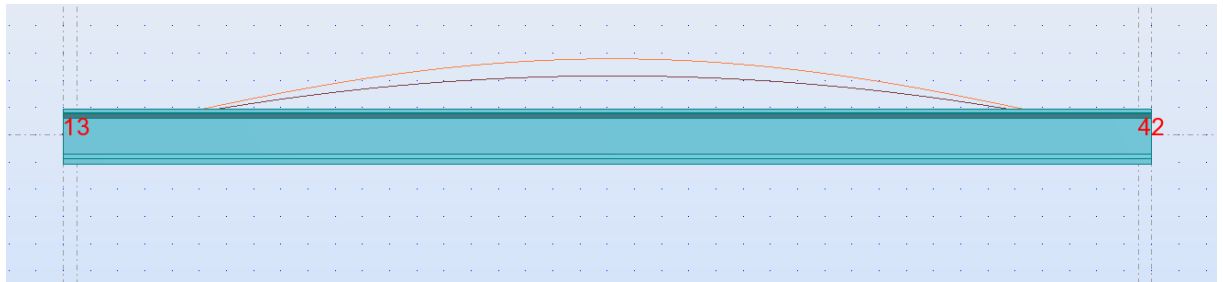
La contre-flèche de la poutre seule avant le coulage de la dalle et mise tension de câble
